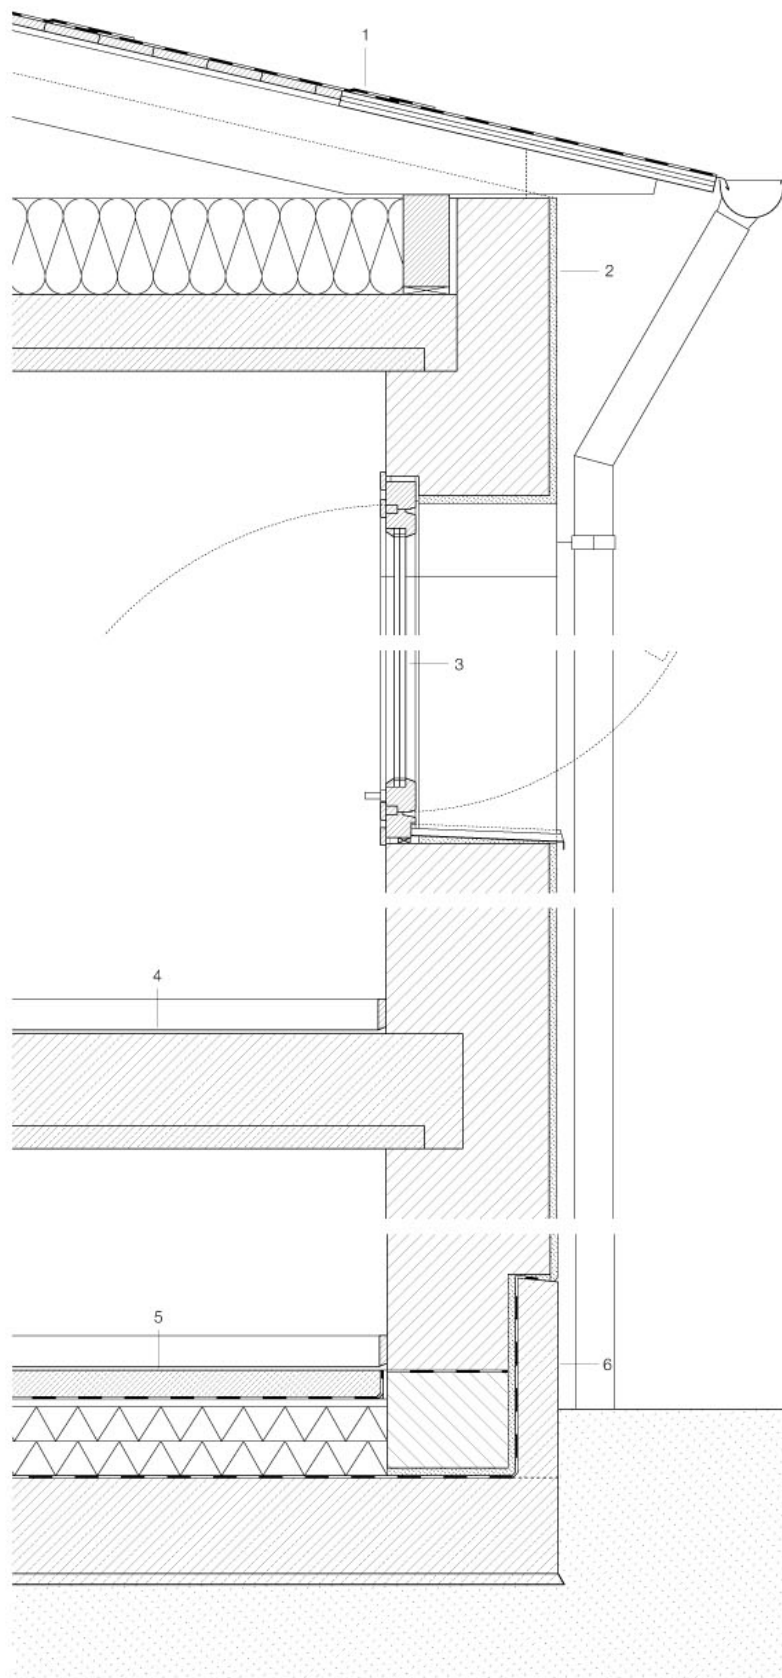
Fassadenschnitt Gebäude Mauerwerk:
